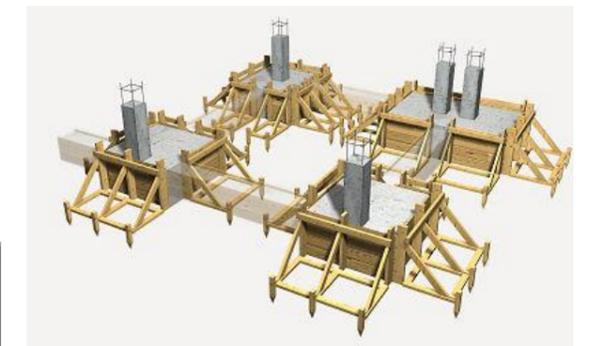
Encofrado de madera para cimentación. 2018. www.generadordeprecios.info/
